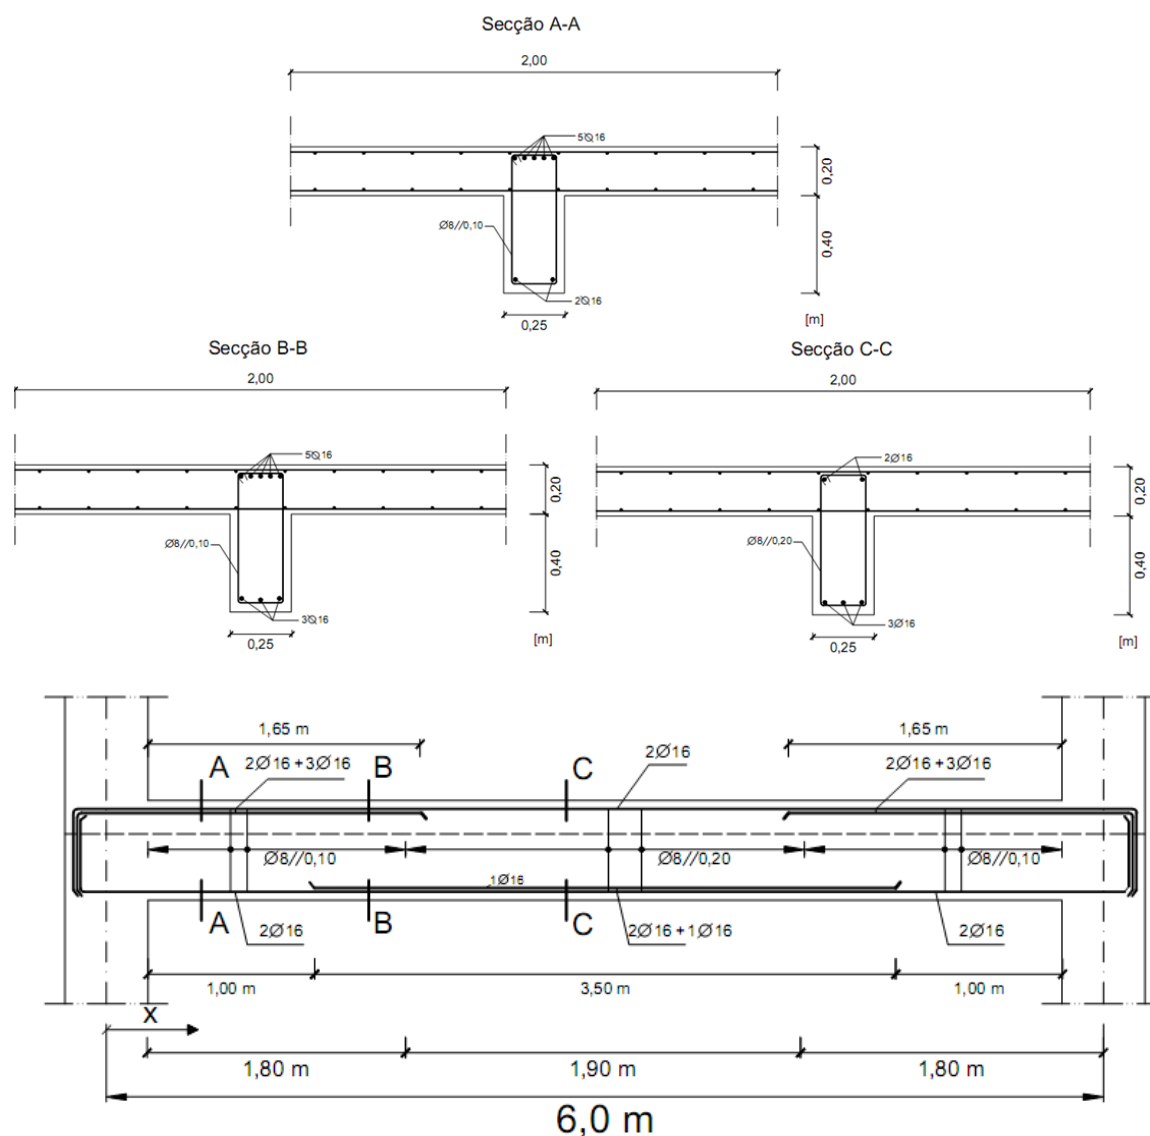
Pormenorização da armaduras (Caso C – secção em T)
